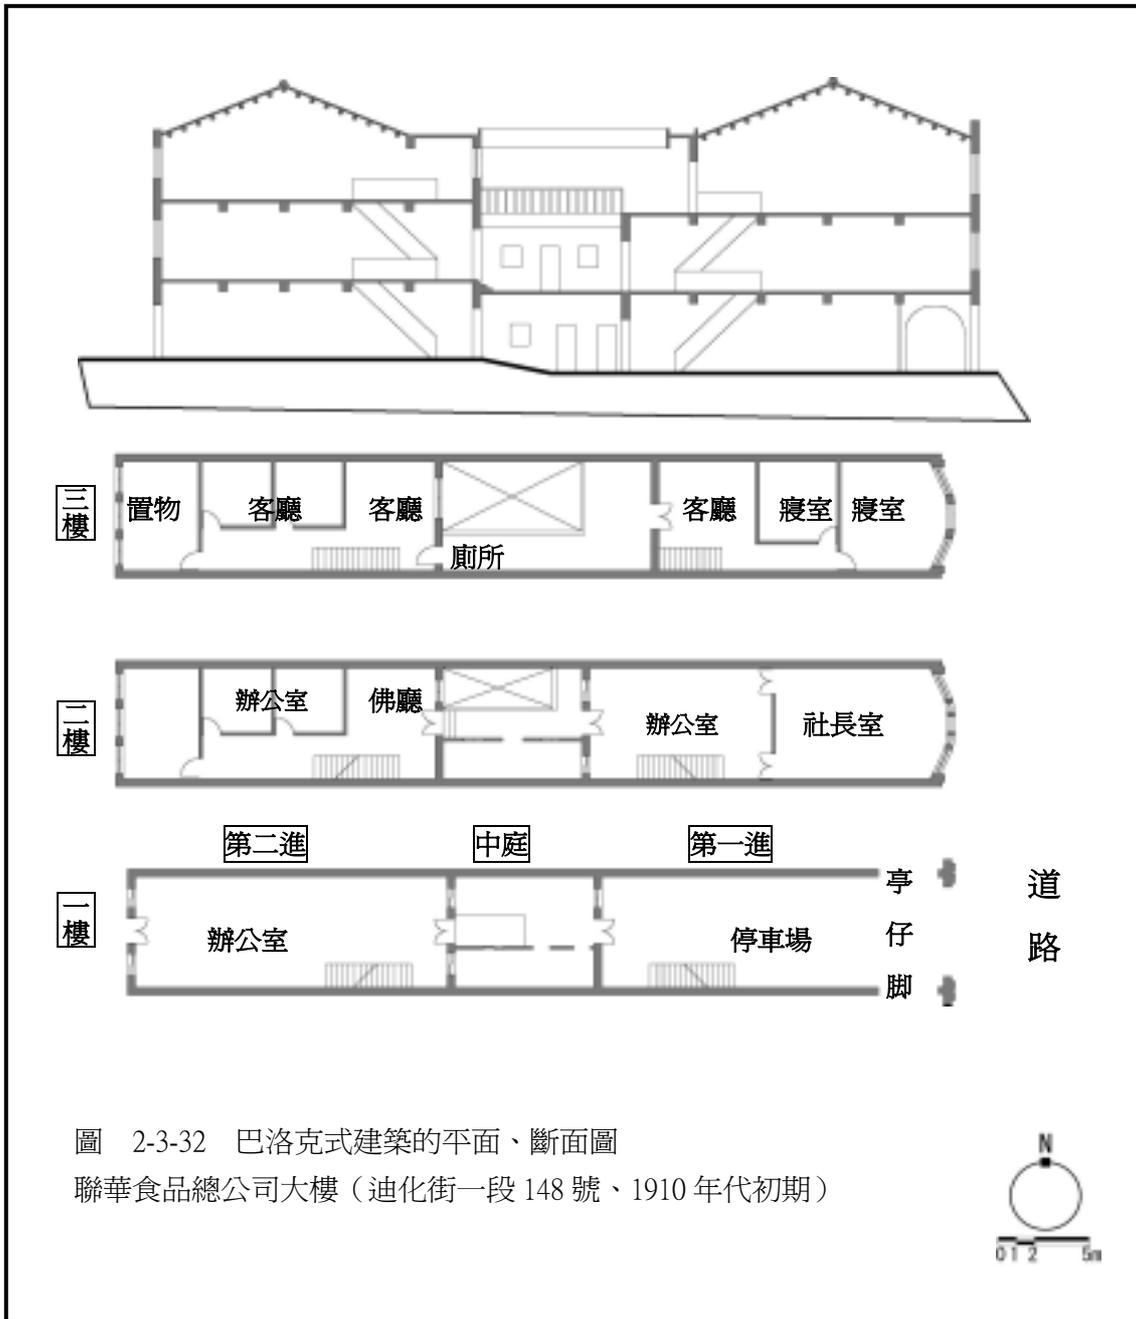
巴洛克式建築的平面、斷面圖
